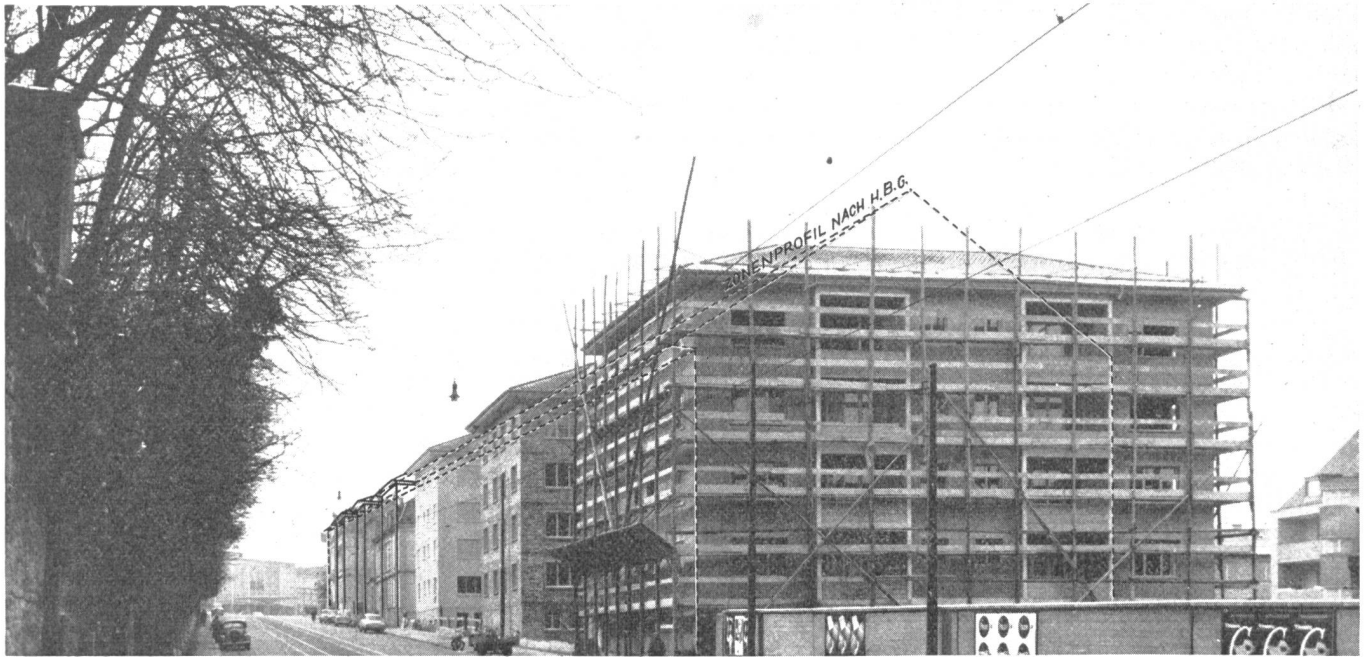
Ansicht der Zürcherstrasse mit der zum Teil bereits verwirklichten Neubebauung gemäss dem angefochtenen Überbauungsplan. In der Aufnahme ist das Profil der ohne den speziellen Überbauungsplan gesetzlich zulässigen, zonenmässigen Randbebauung eingetragen.
